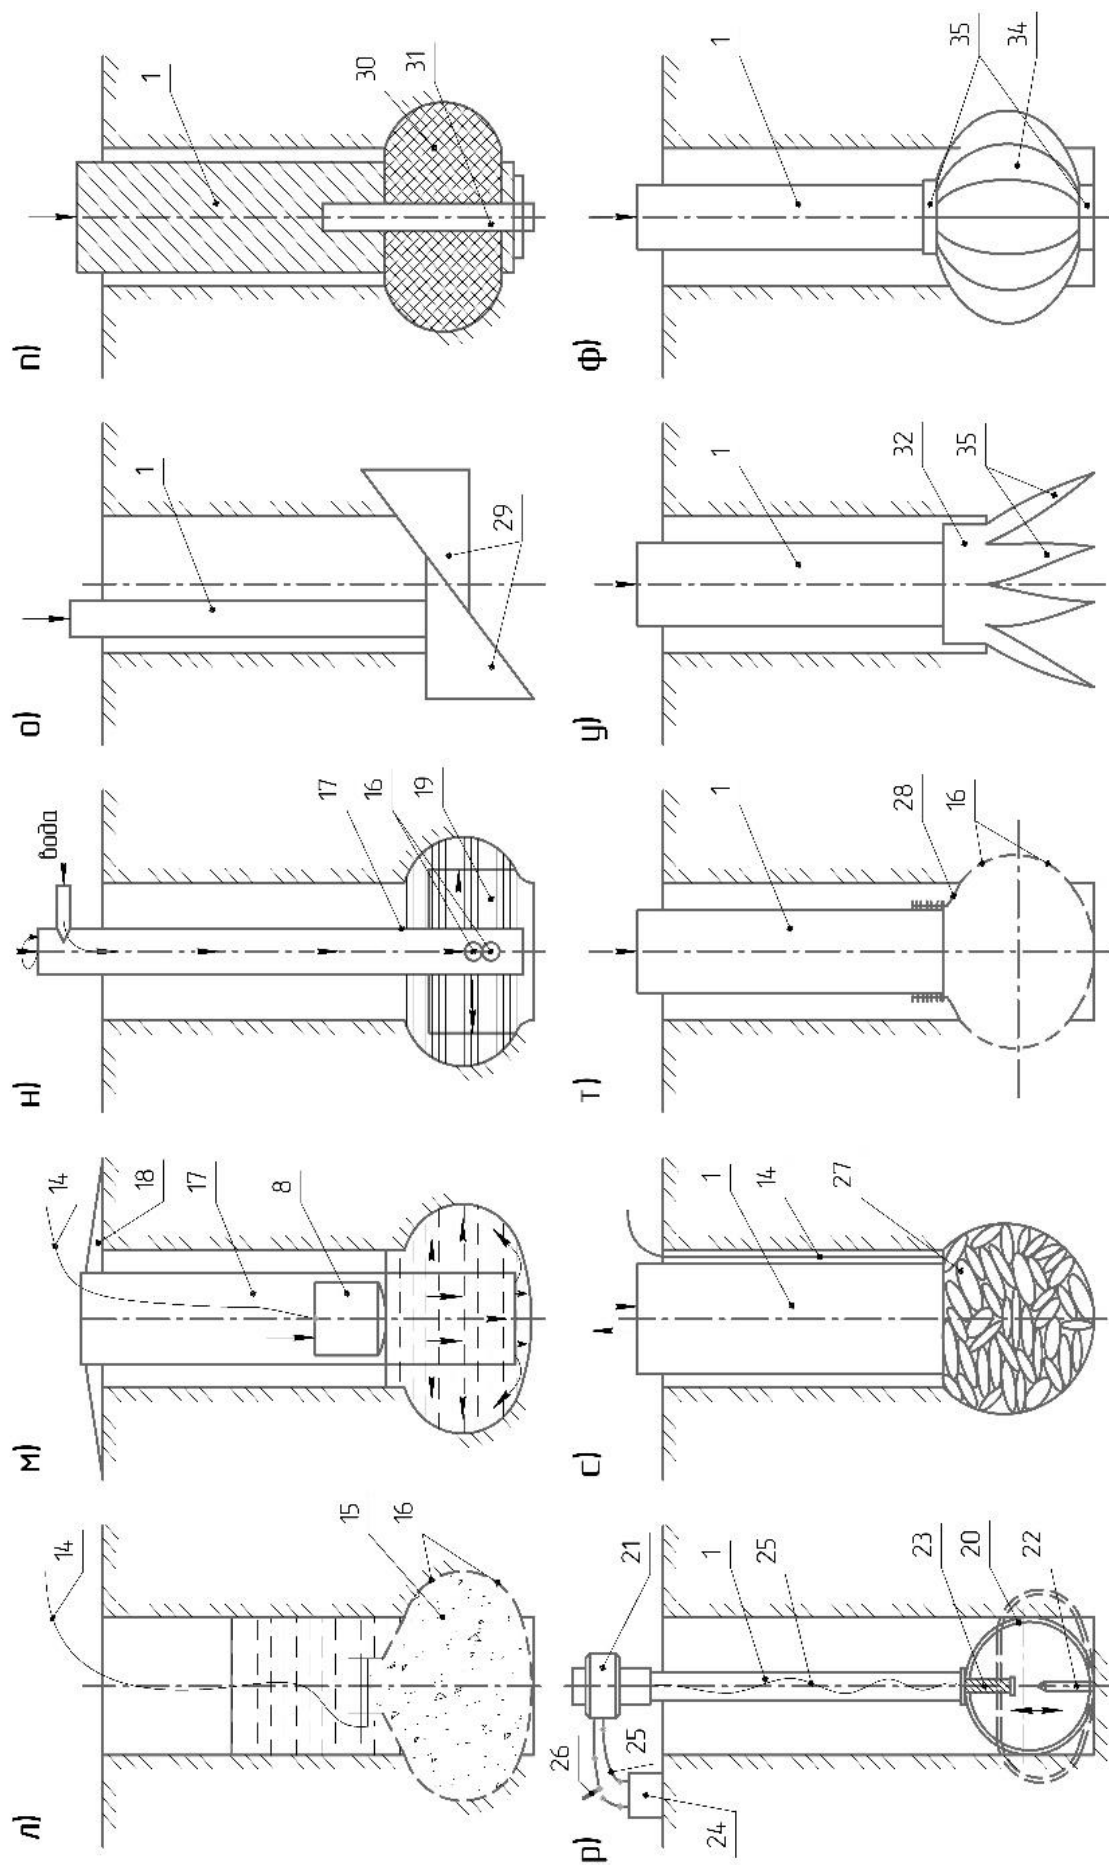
Прогрессивные конструкции устройств и приспособлений для образования уширений в забое скважин.
